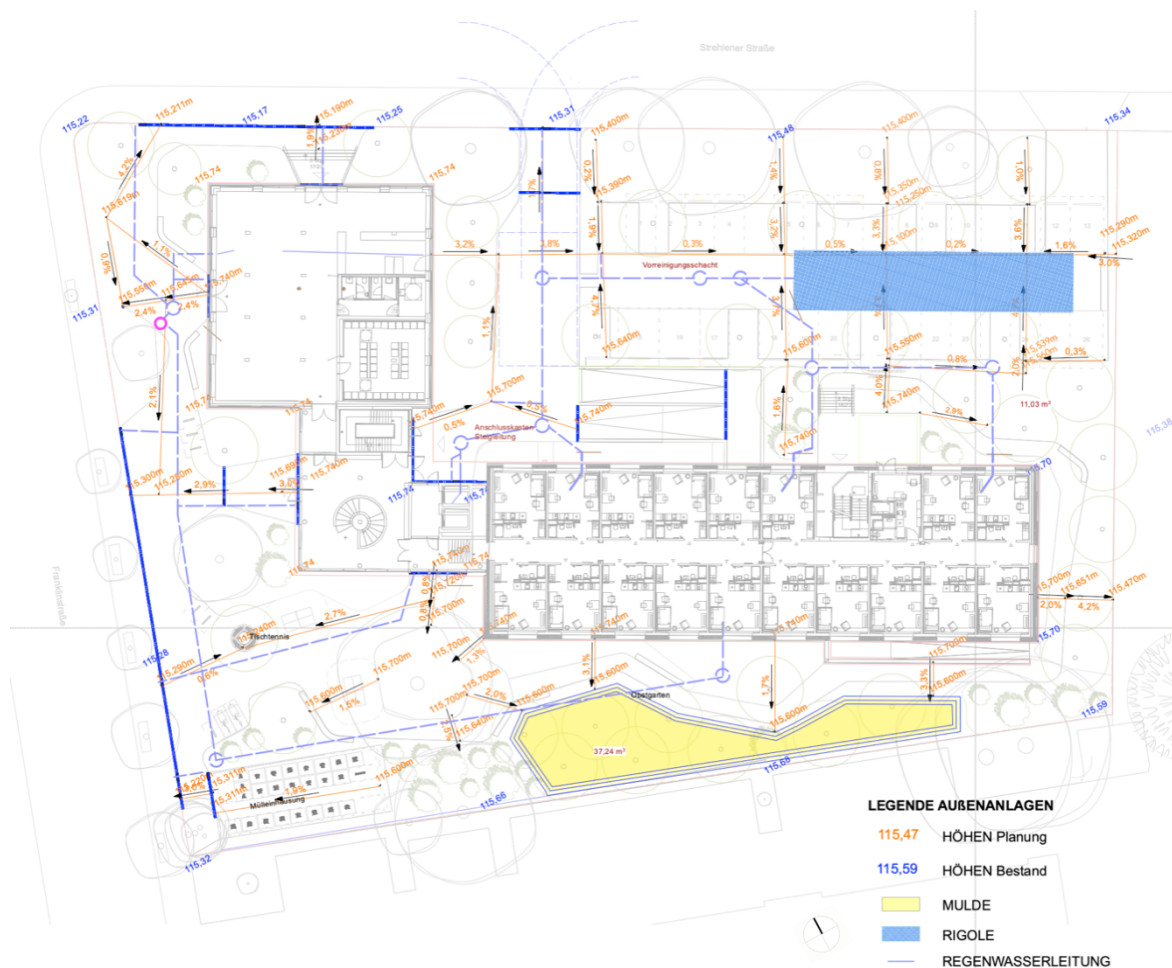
Lageplan mit Zonierung der befestigten Flächen nach DIN 1986-1, Tabelle 9. (STORCH.LANDSCHAFTSARCHITEKTUR 2024)
